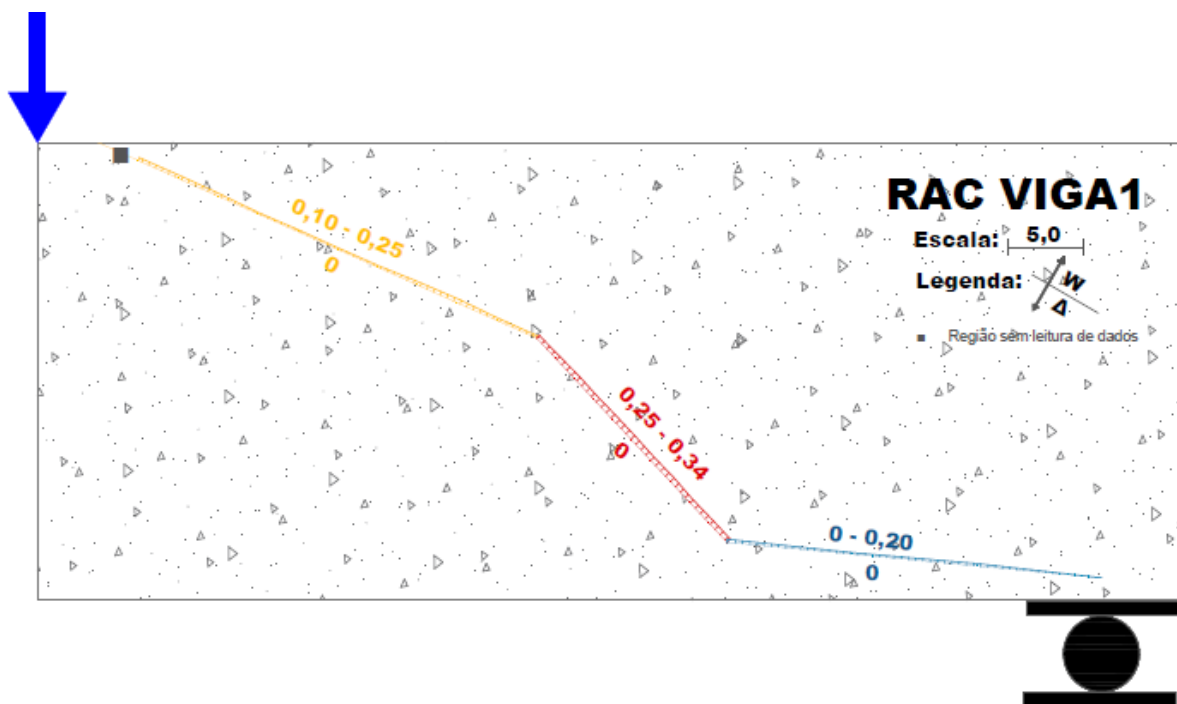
Abertura (w) e deslizamento (Δ) da fissura diagonal crítica da viga RAC-1.
